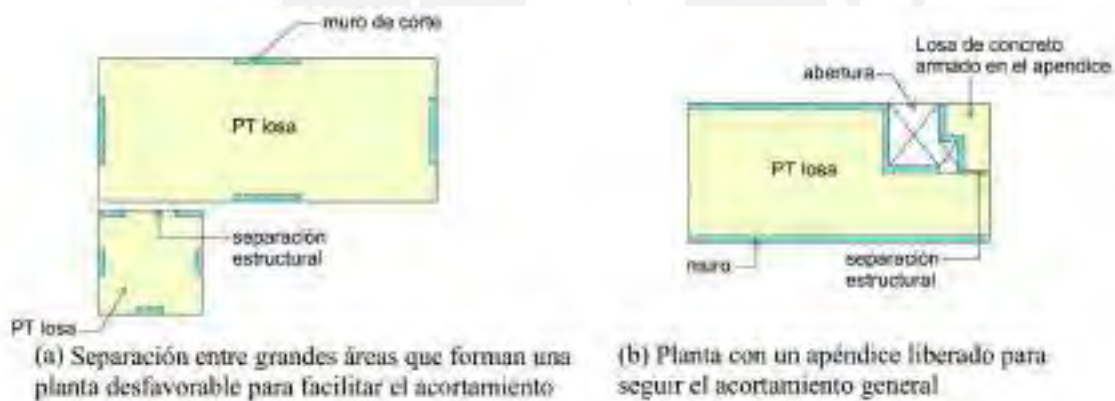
Juntas de separación entre losas (Fuente: ADAPT, 2016)
